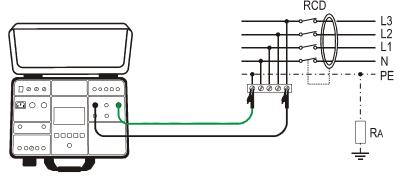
Ligação das ponteiras de teste à cablagem em teste
